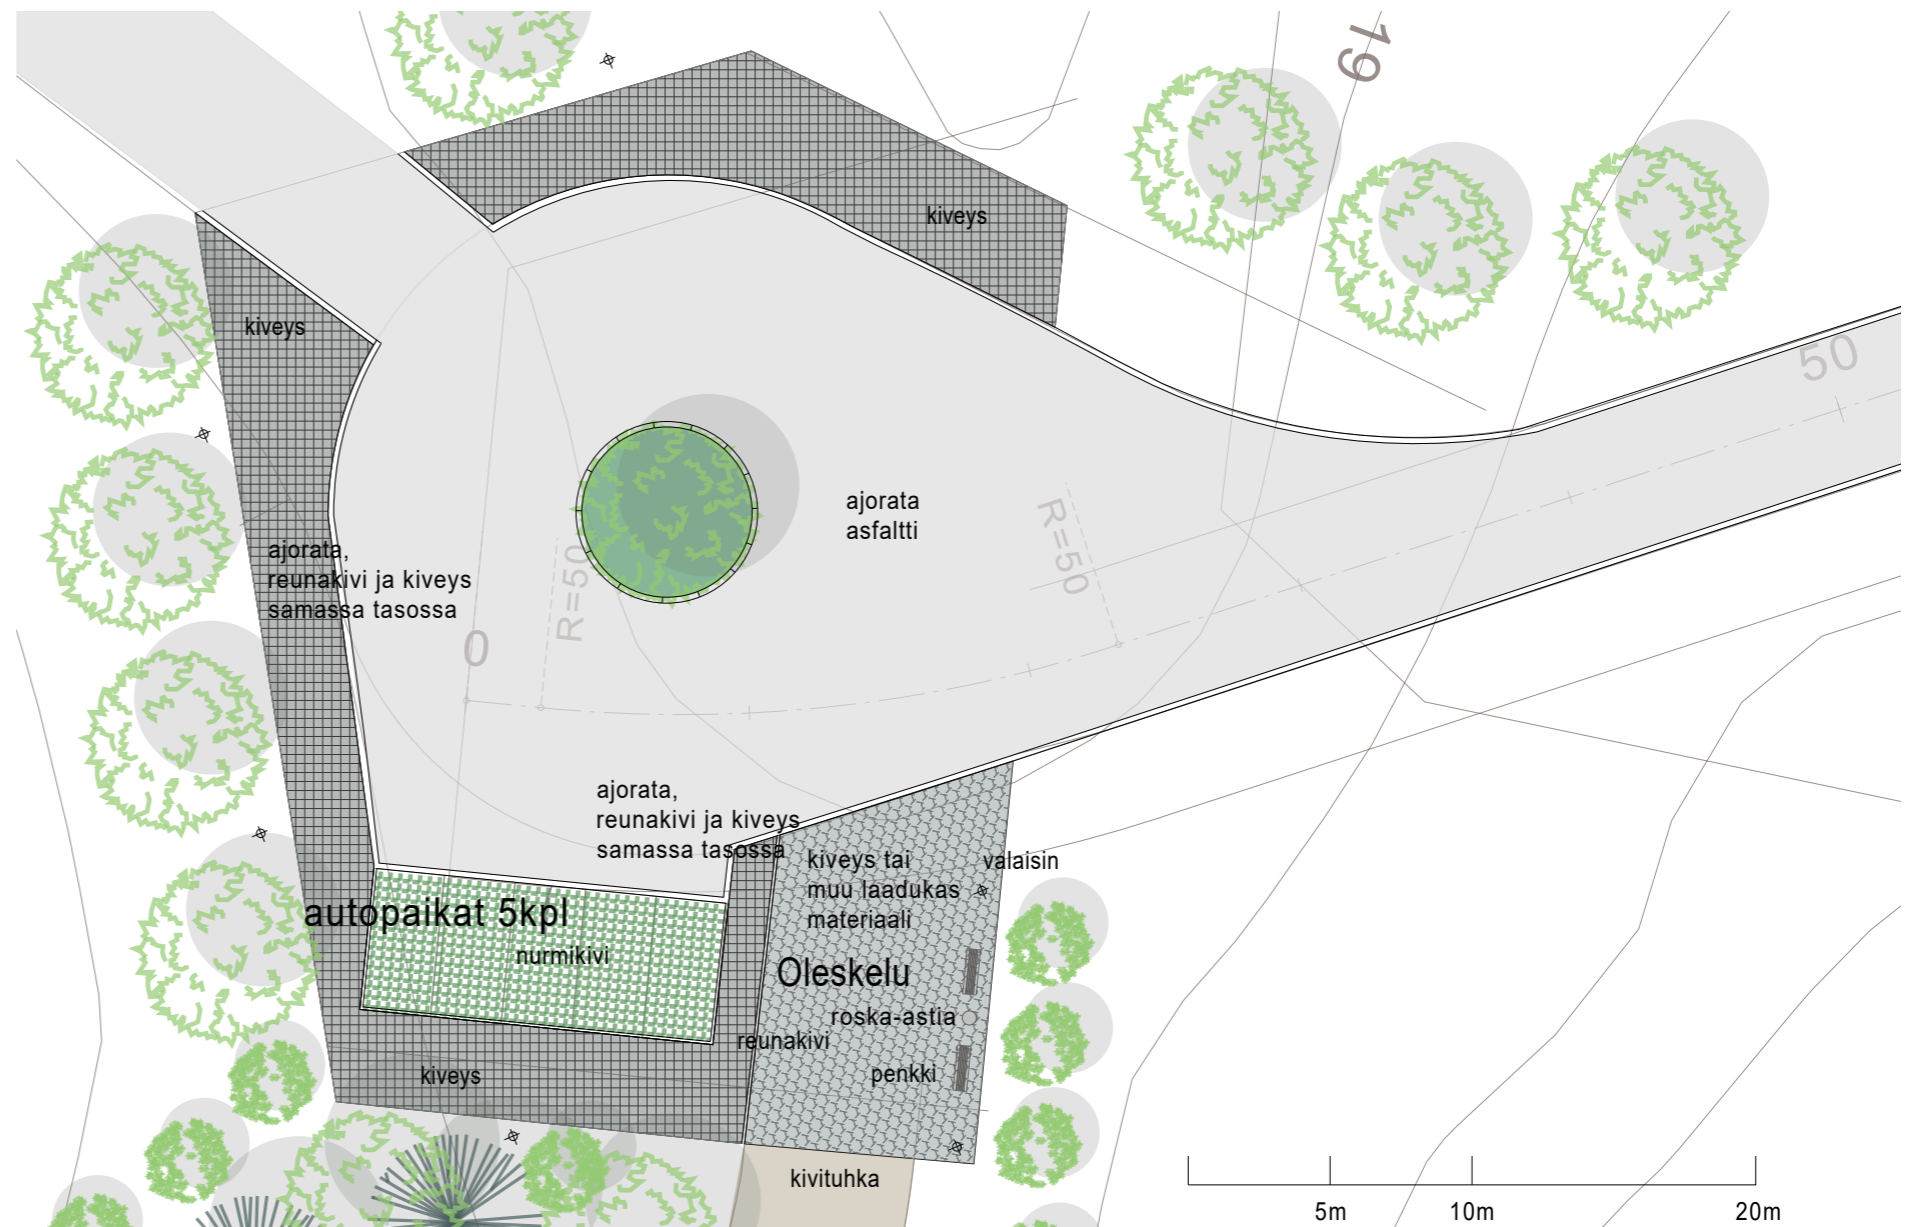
Idéartad plan för torget som bildas mellan kvarteren.
